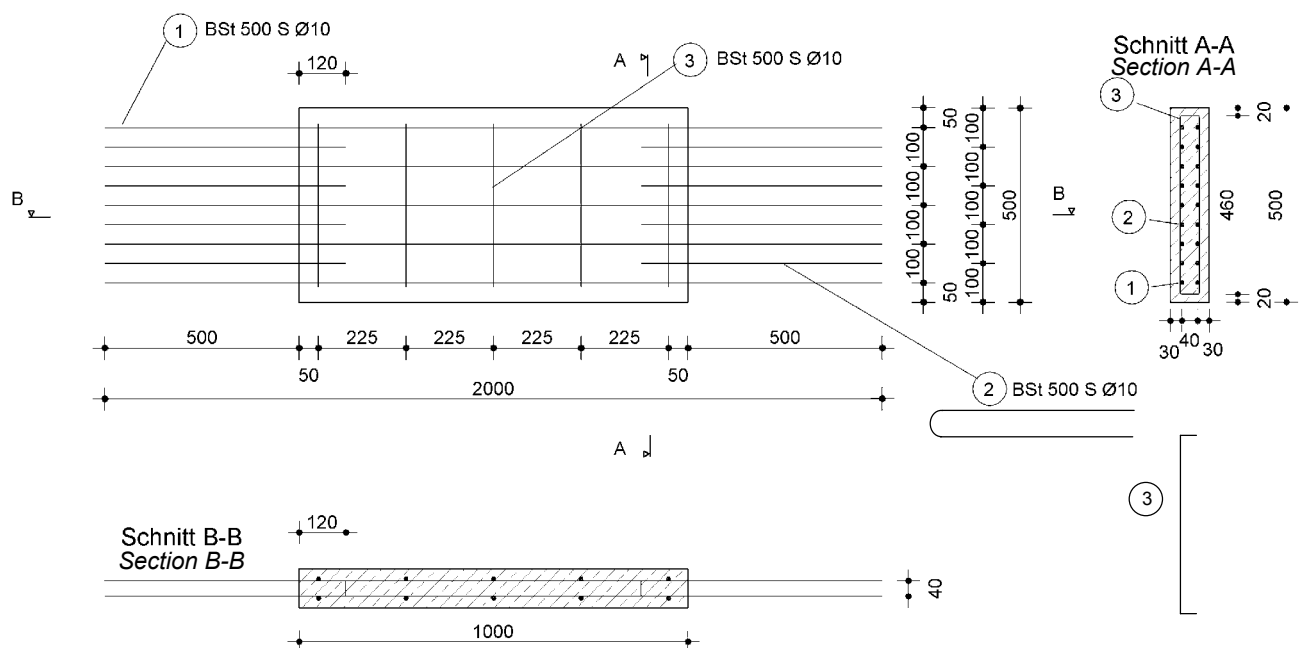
Bewehrungsplan für die bewehrten Betonscheiben
